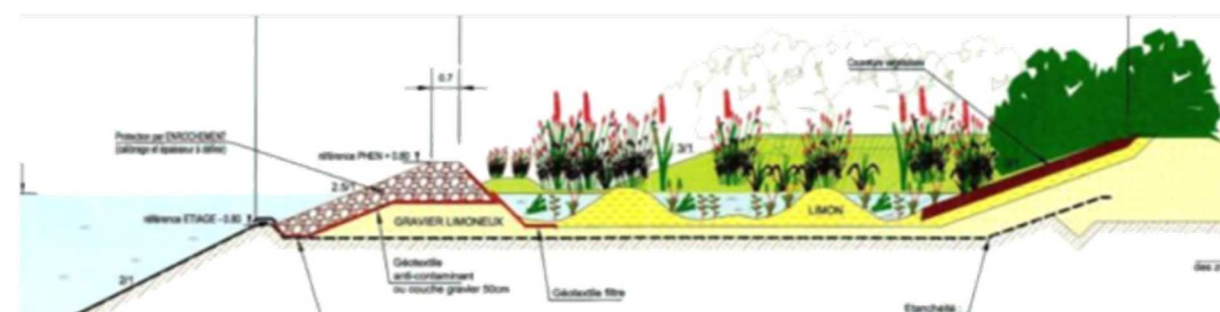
Coupe transversale type d'une berge lagunée (source : CNR)
